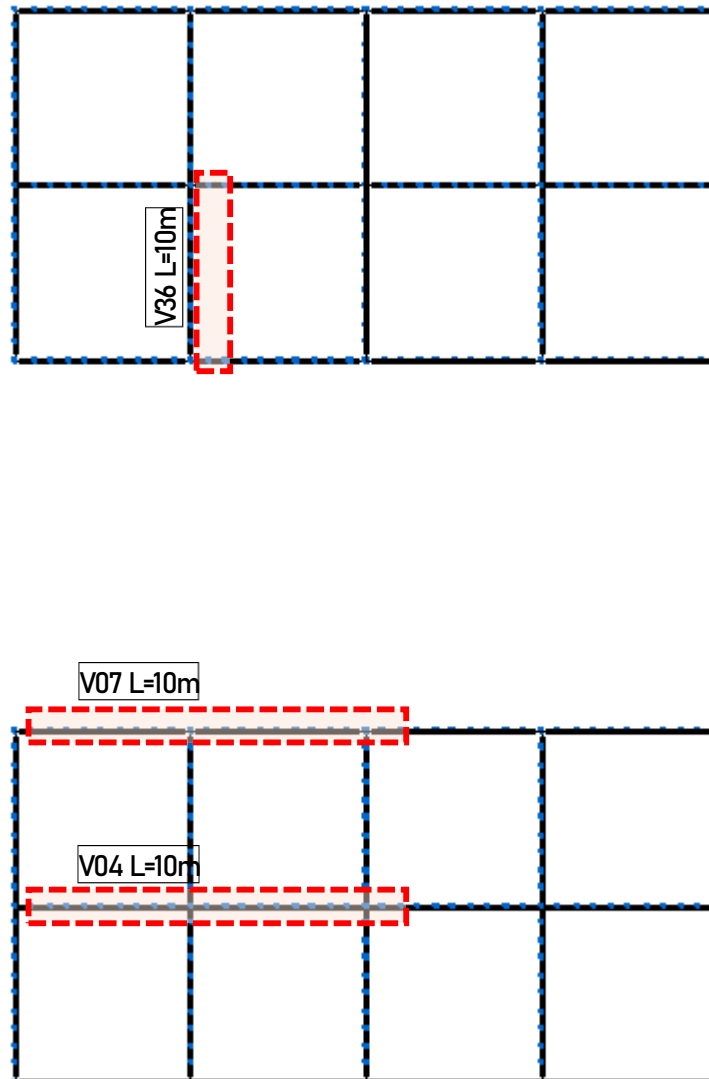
Geometría Modelo CYPE 3D – barras Planta Alta
